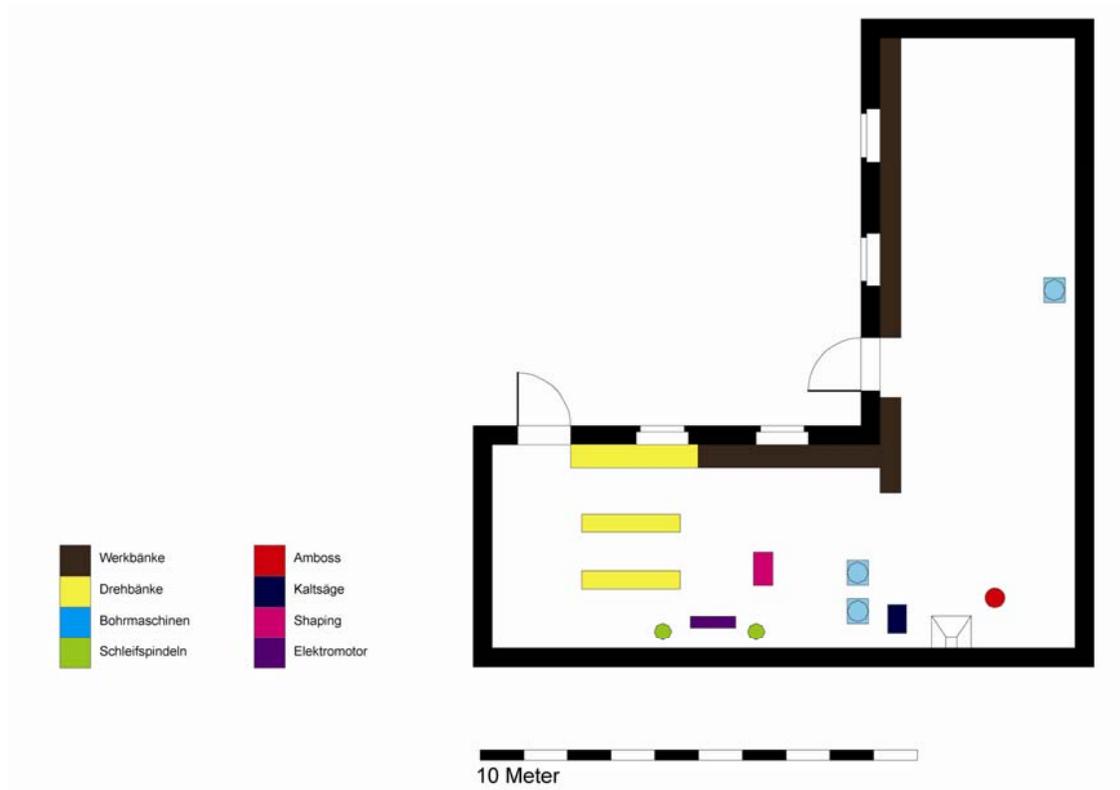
Werkstättengrundriss Holoergasse 20 mit Einrichtung um 1920
